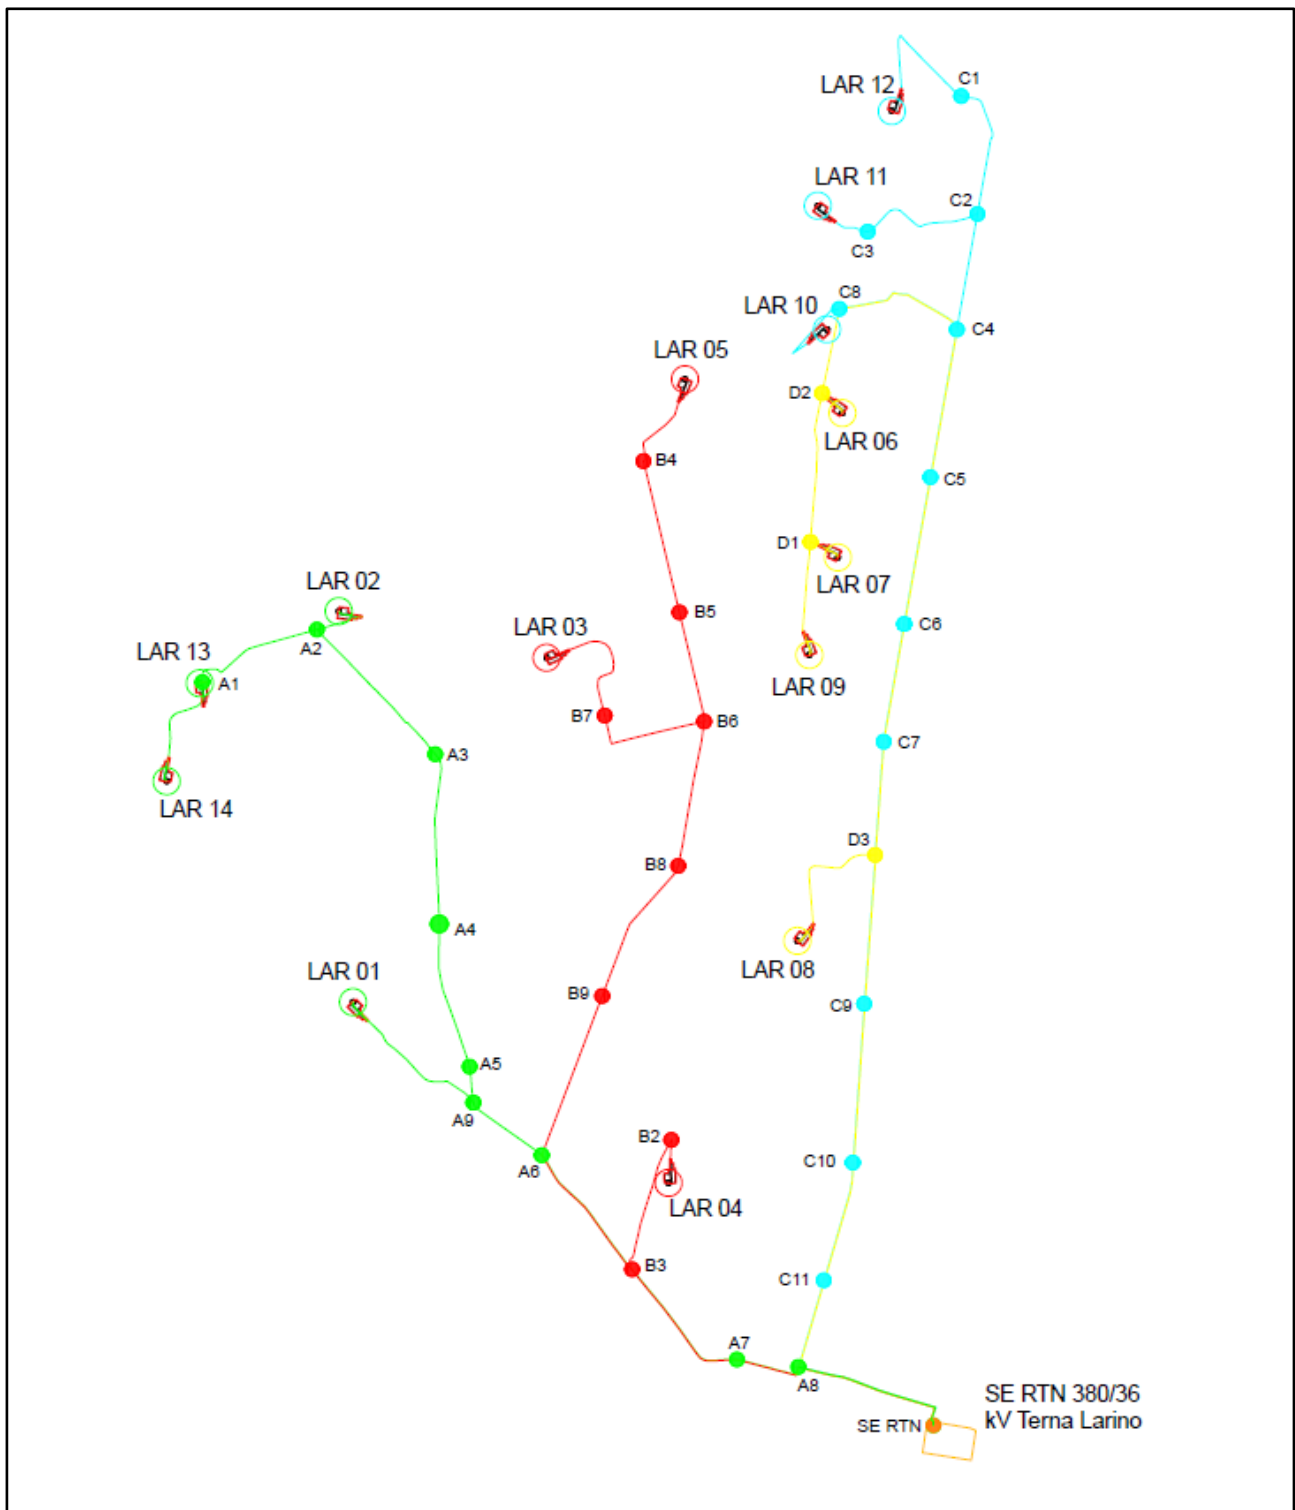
Planimetria di distribuzione linee a 36 kV dell'intero impianto
